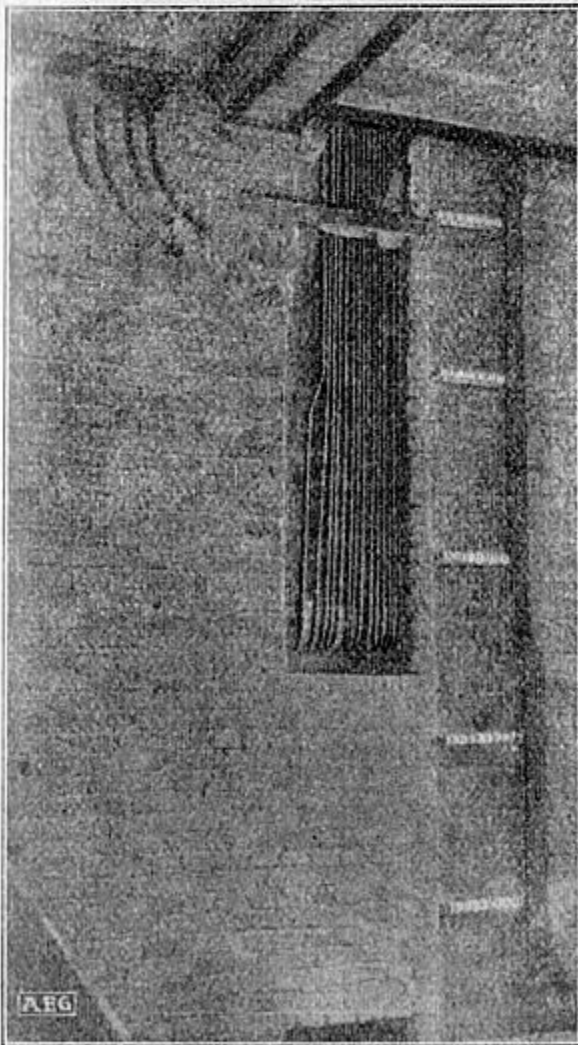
Stahlpanzerrohre über einem Deckendurchbruch.
